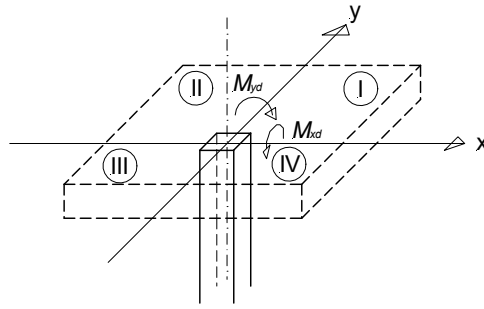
Definition der Grundrissparameter für Berechnungsformeln
